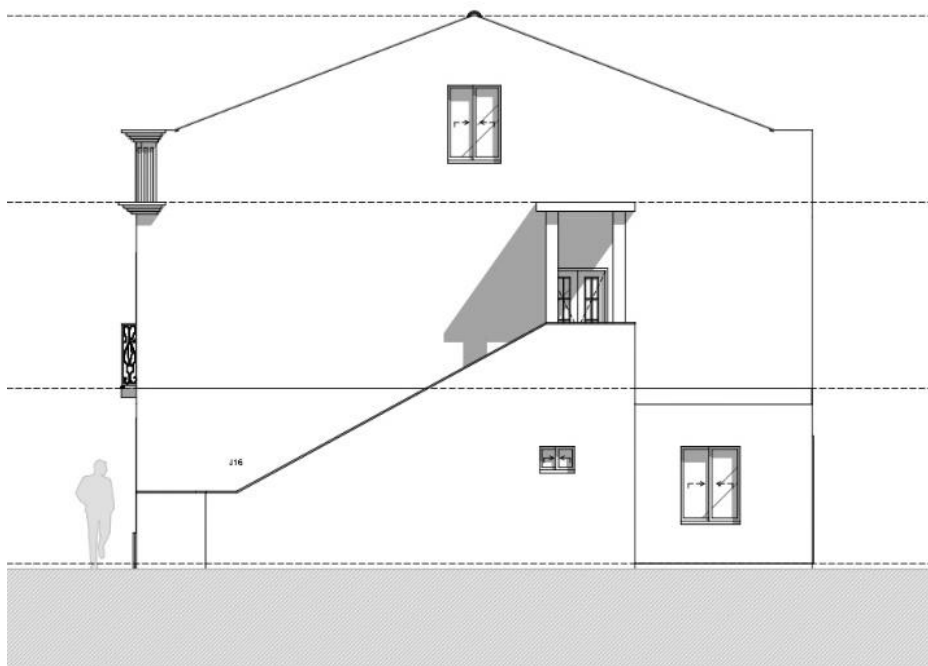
Alçado existente lateral direito (acervo do autor 2024)
